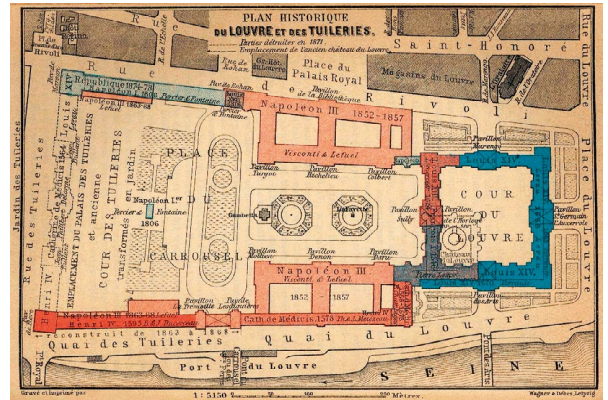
Planta histórica do Louvre e das Tulherias com faseamento de construção.
